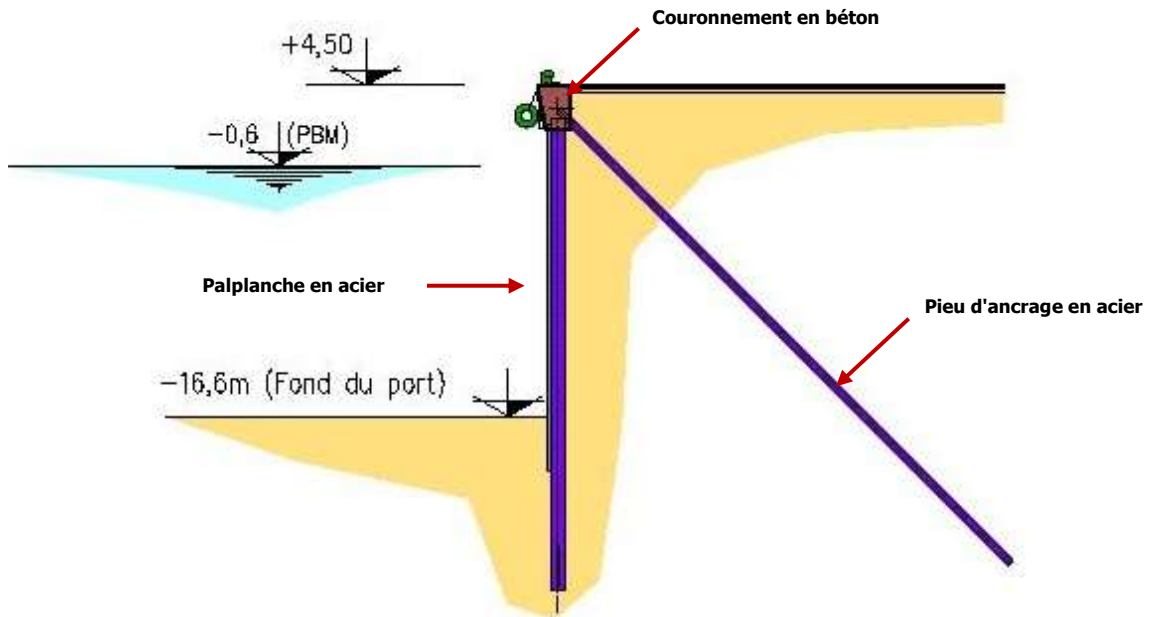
Mur en palplanches avec ancrage arrière – Coupe transversale
